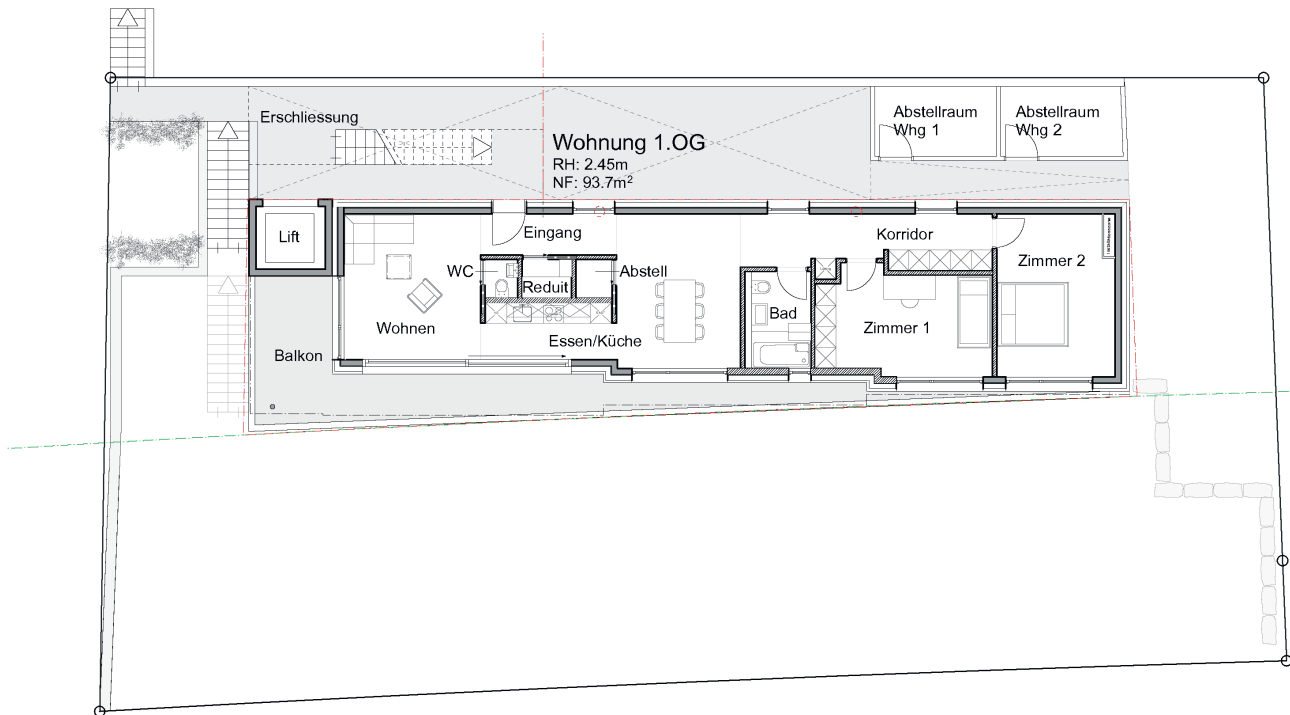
Grundriss 1. Obergeschoss (Wohnung)
